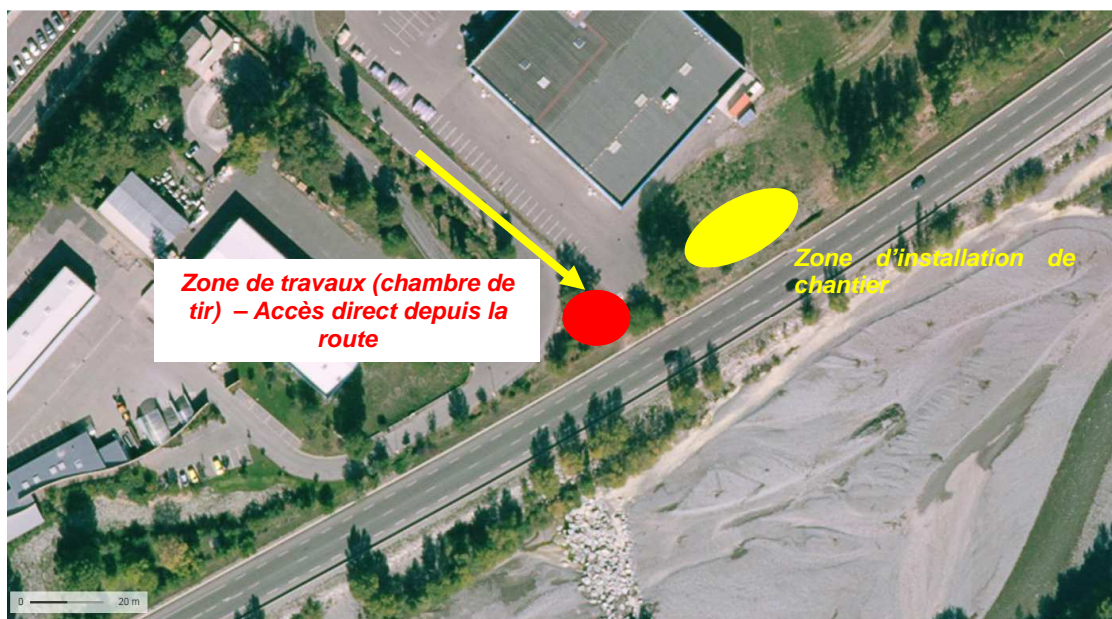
Accès et installation de chantier pour les travaux liés à la conduite d'eaux usées – RIVE DROITE
